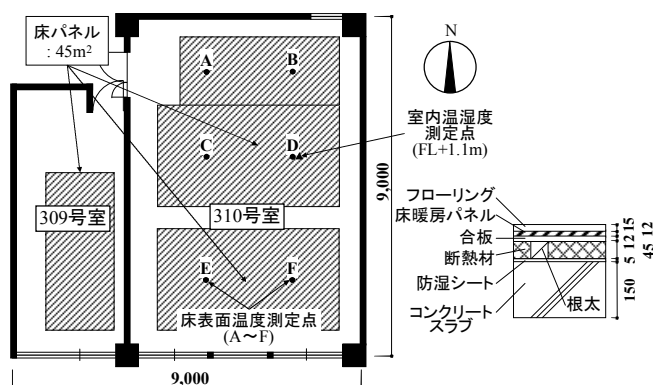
実大実証試験施設(空調対象室)の平面図・床断面図
